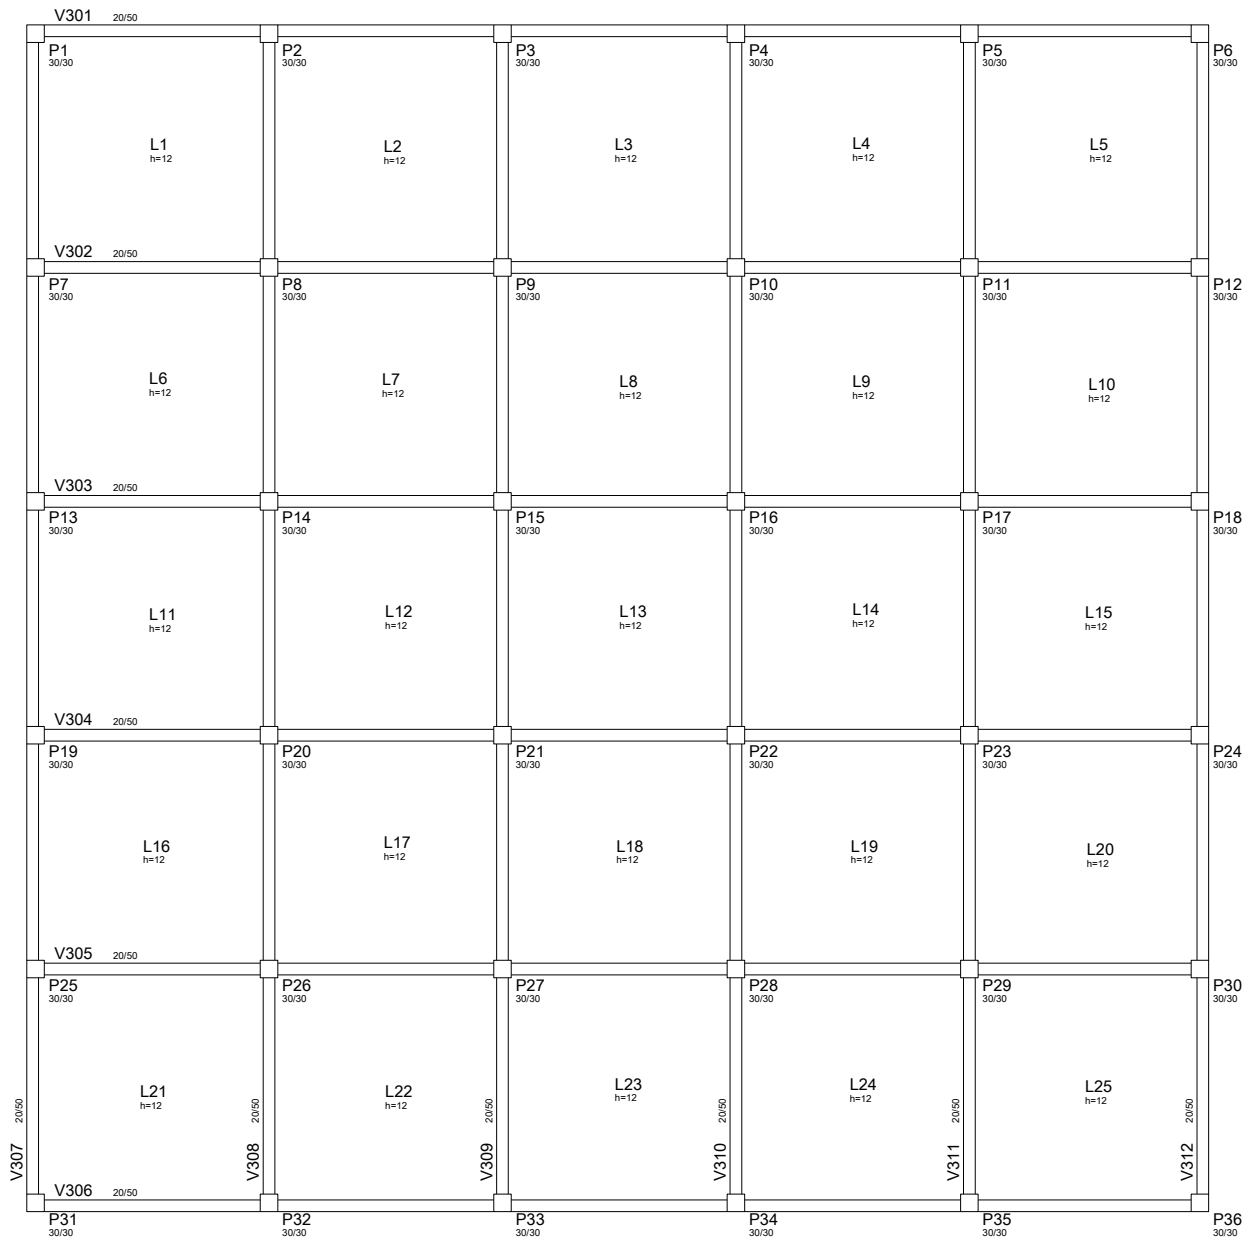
Planta de formas do pavimento tipo do Edifício Exemplo, sem escala
